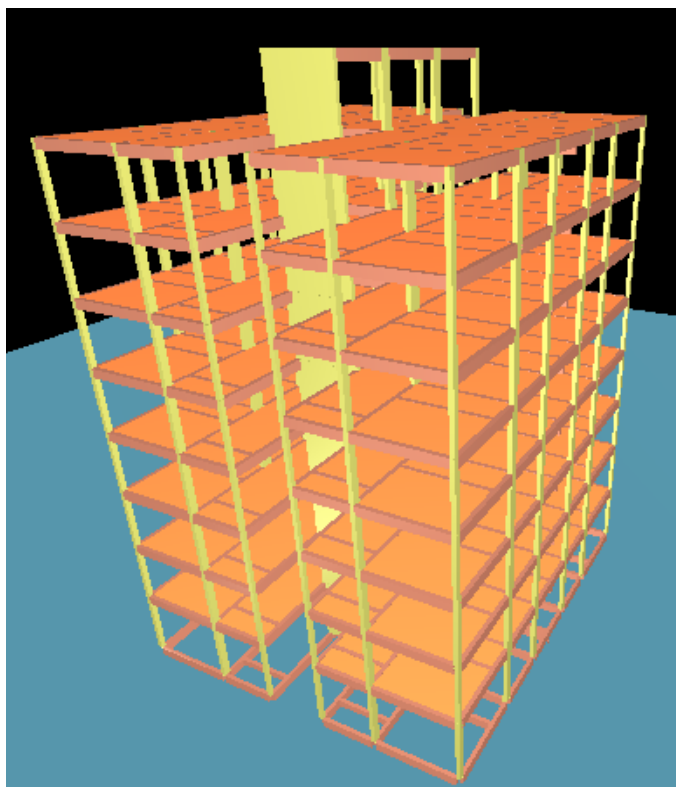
Sistema de pórtico tridimensional da estrutura convencional vinculada a um núcleo rígido - Fonte: Adaptado do CAD/TQS (2016).
